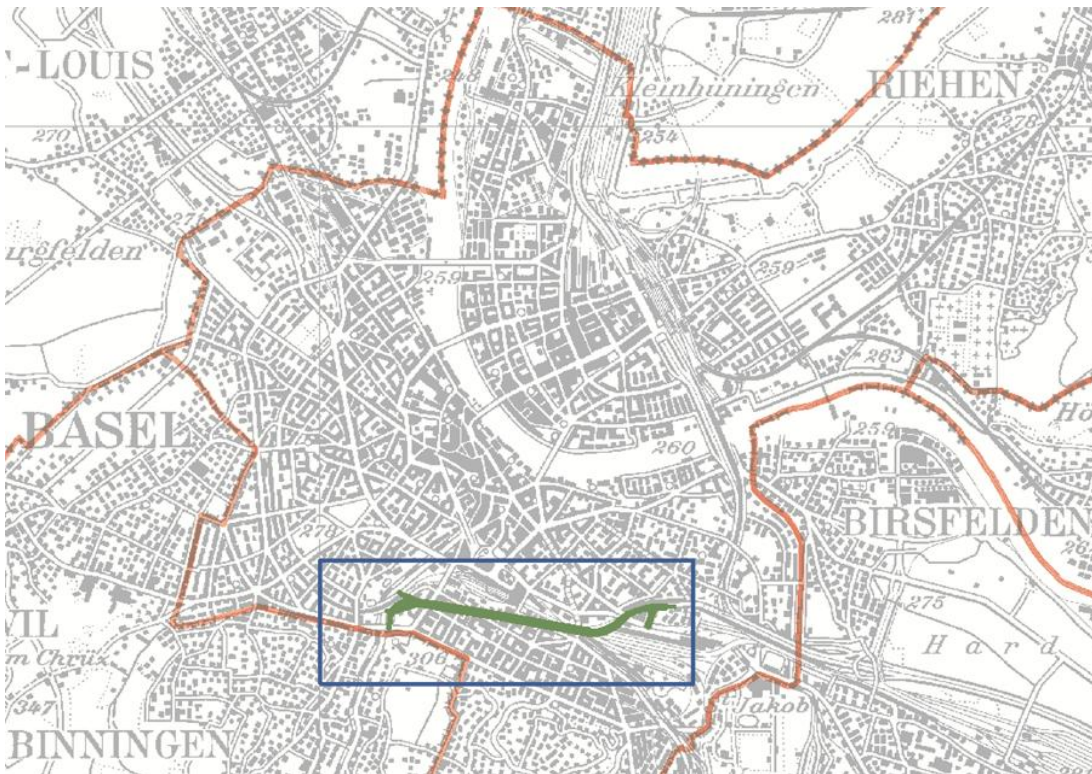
Lageplan Tunneltrasse „Anschluß Margarethenstrasse“ – „Anschluß St. Jakobsstrasse West“ (grün, A2-Abschnitt7). Der Tunnelbau soll auf einer Strecke von ca. 1500 m bergmännisch im Untertagebau und auf einer Strecke von 400 m in Deckelbauweise realisiert werden. Perimeter lokales Arbeitsmodell (blau).
